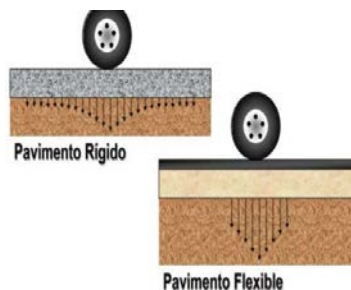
Representación de las cargas en pavimentos rígidos y flexibles.
